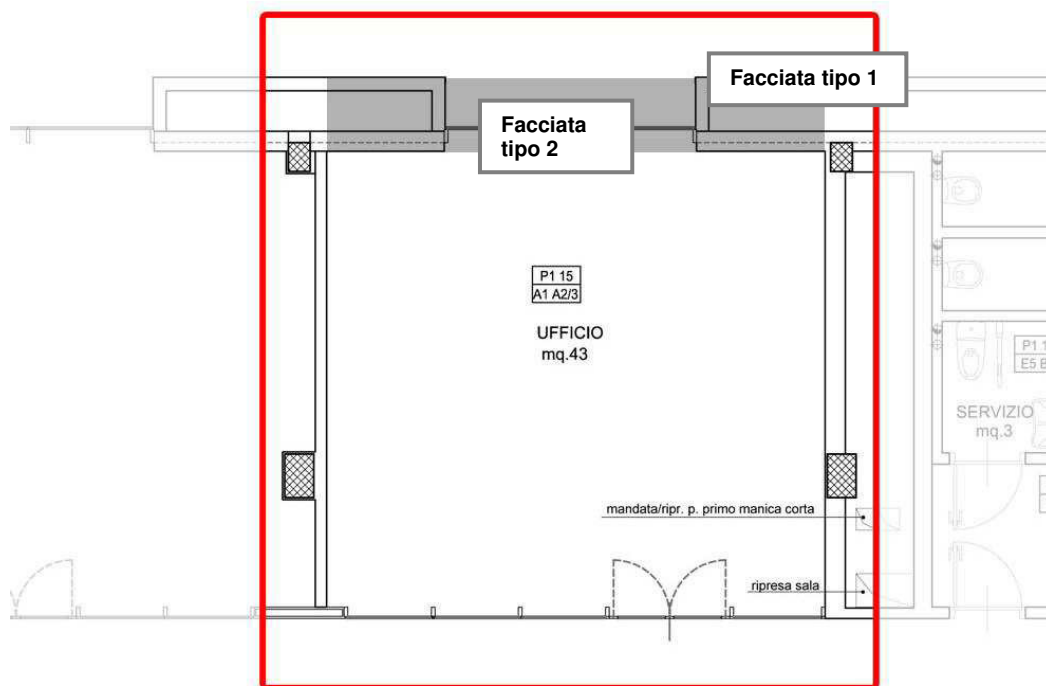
Dettaglio pianta primo piano con individuazione della parete di facciata.
